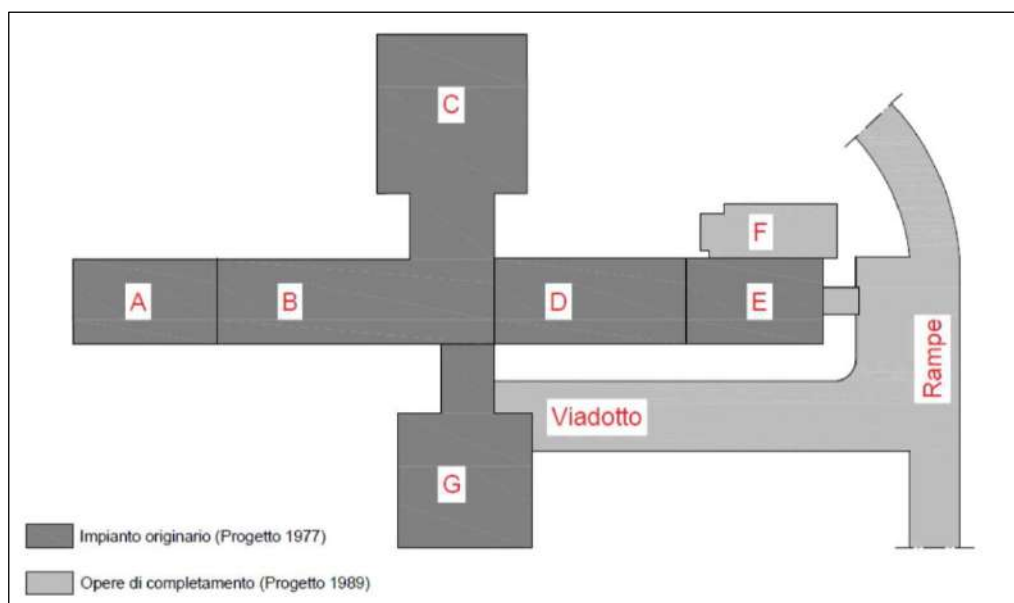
Schema planimetrico del Padiglione A alla fine degli anni '80.
